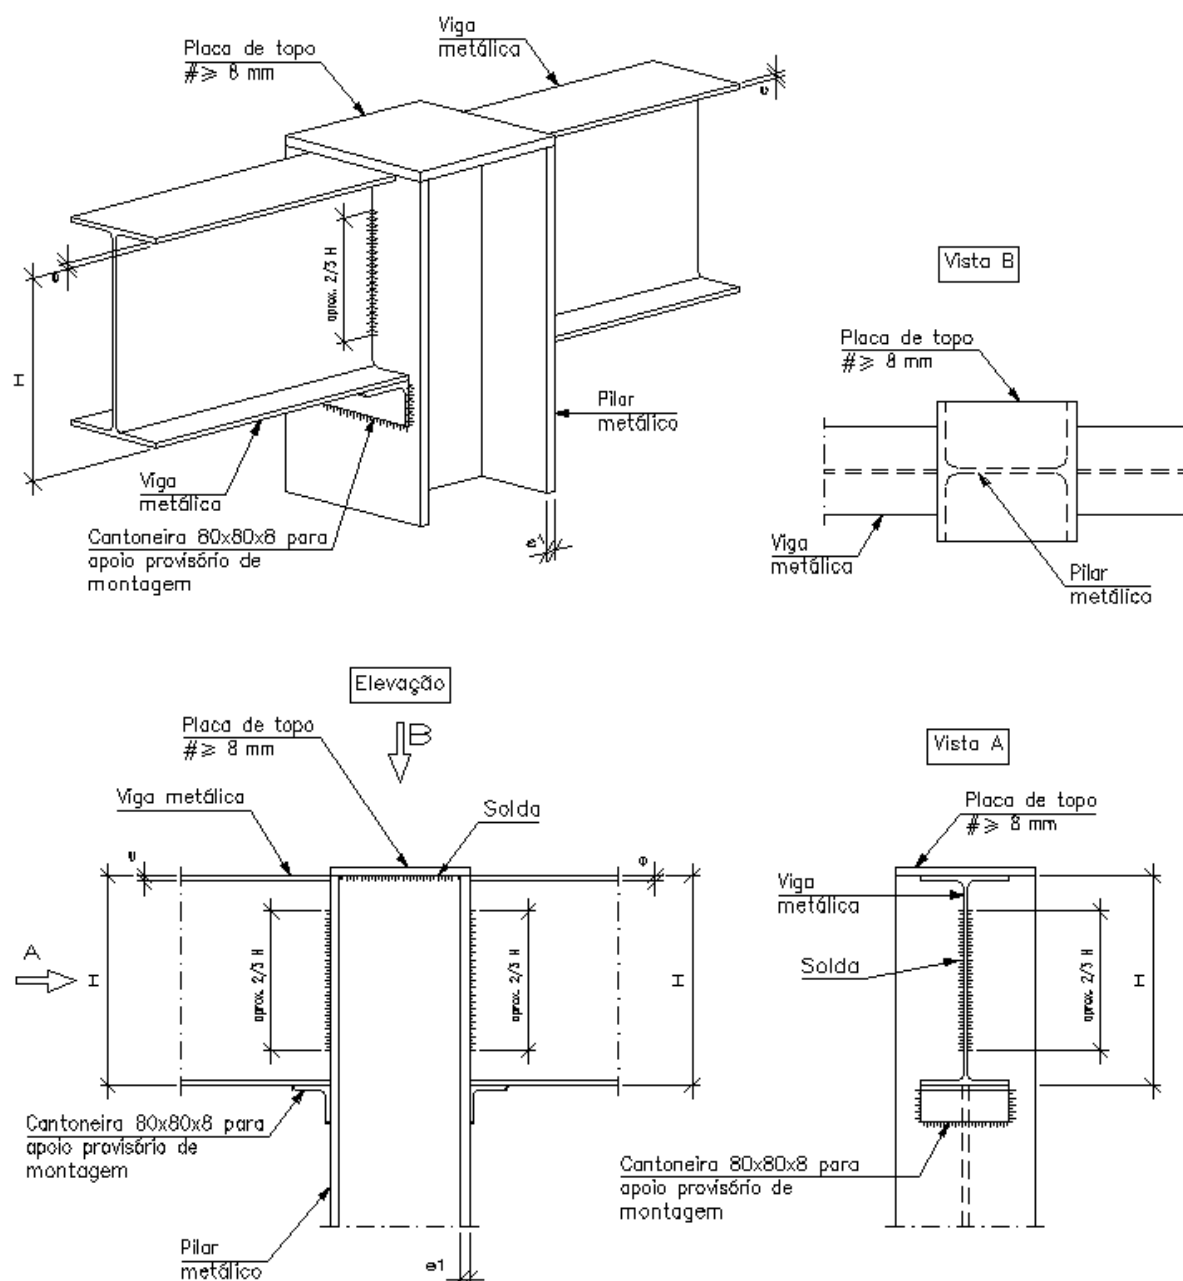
Ligação articulada no extremo do vão duma viga com pilar da última planta
